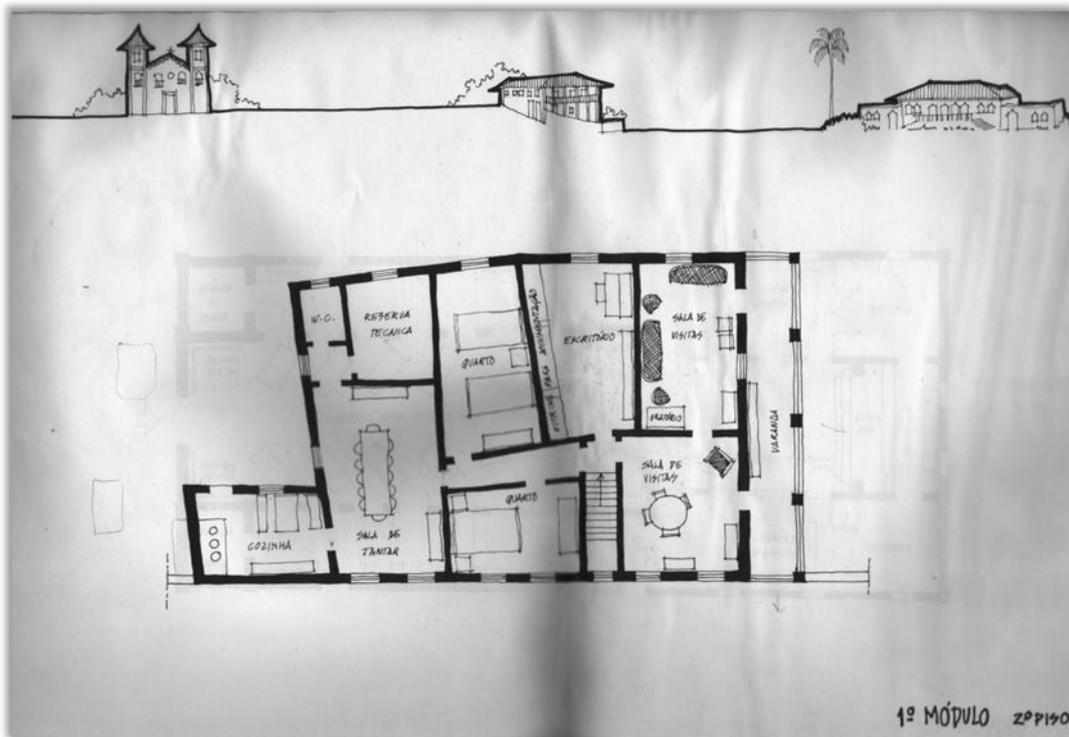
Prancha 4 – primeiro módulo, planta do 2º piso da Casa dos Ottoni.
